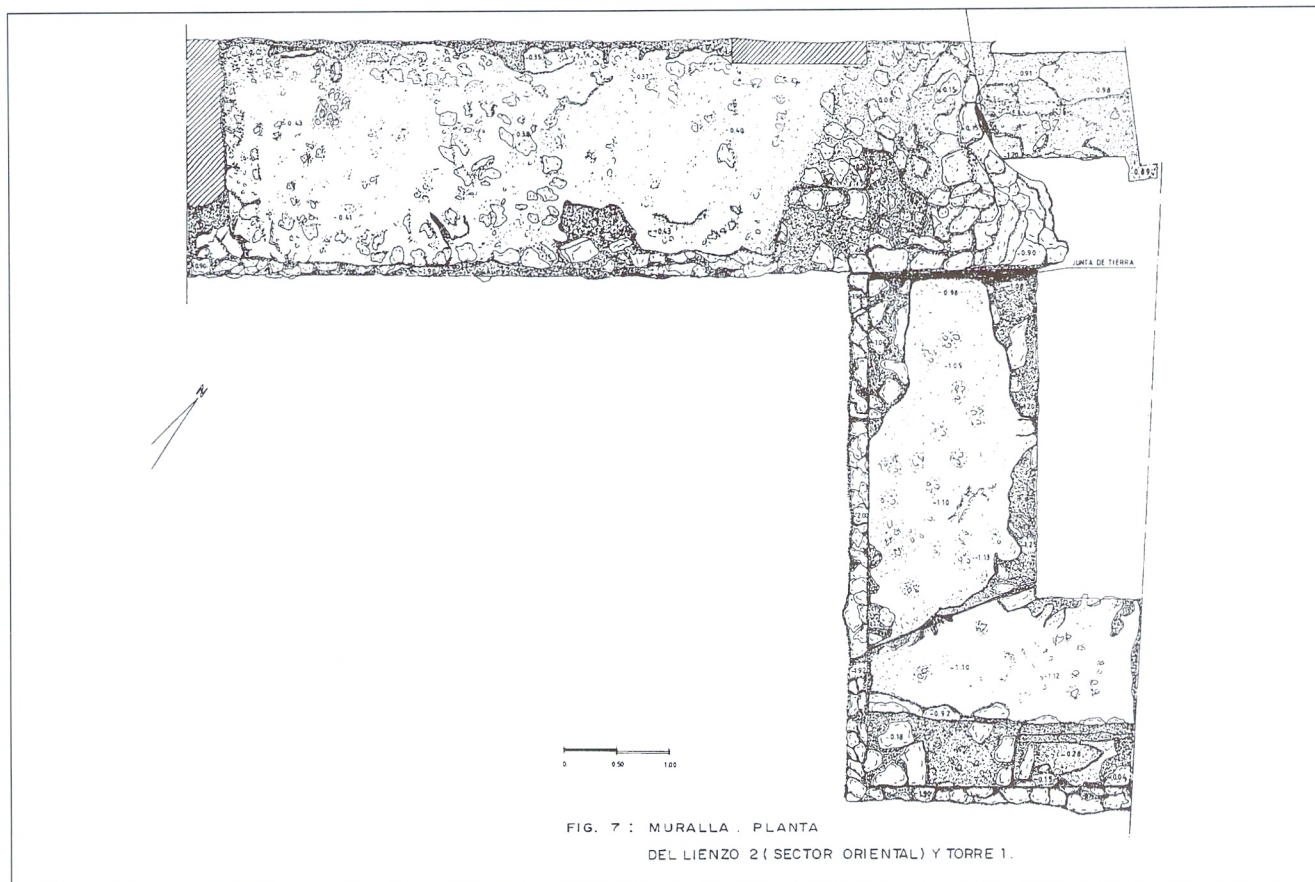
MURALLA, LIENZO 2 (SECTOR ORIENTAL) Y TORRE 1, PLANTA.
